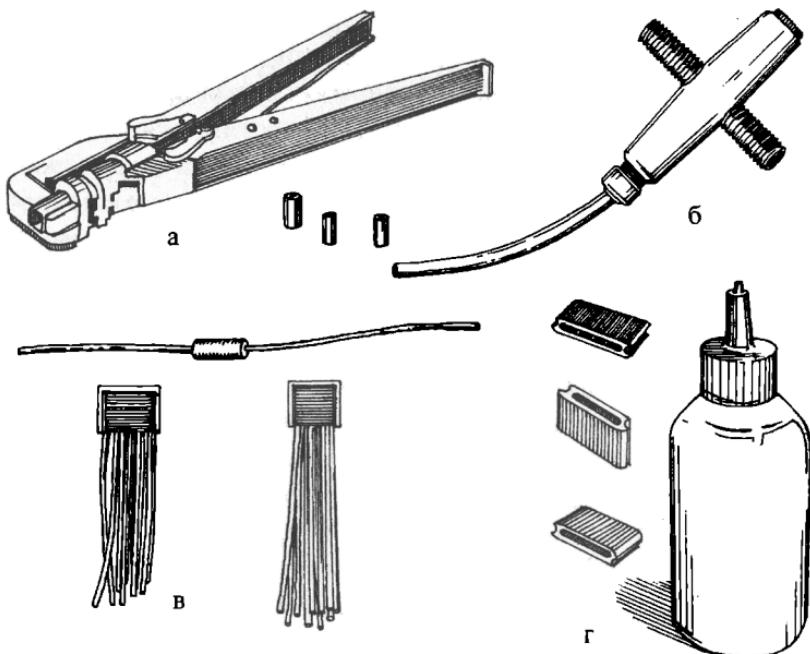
Соединительные приспособления: а — пресс-клещи ПК-3 и гильзы ГАО; б — соединительные клеммы «Wago»; в — пластиковые соединители СПЭП и специальный ключ для срашивания проводов; г — пластиковые пластины-закрепы ПК, прикрепляемые к стене kleem «БМК-5»
